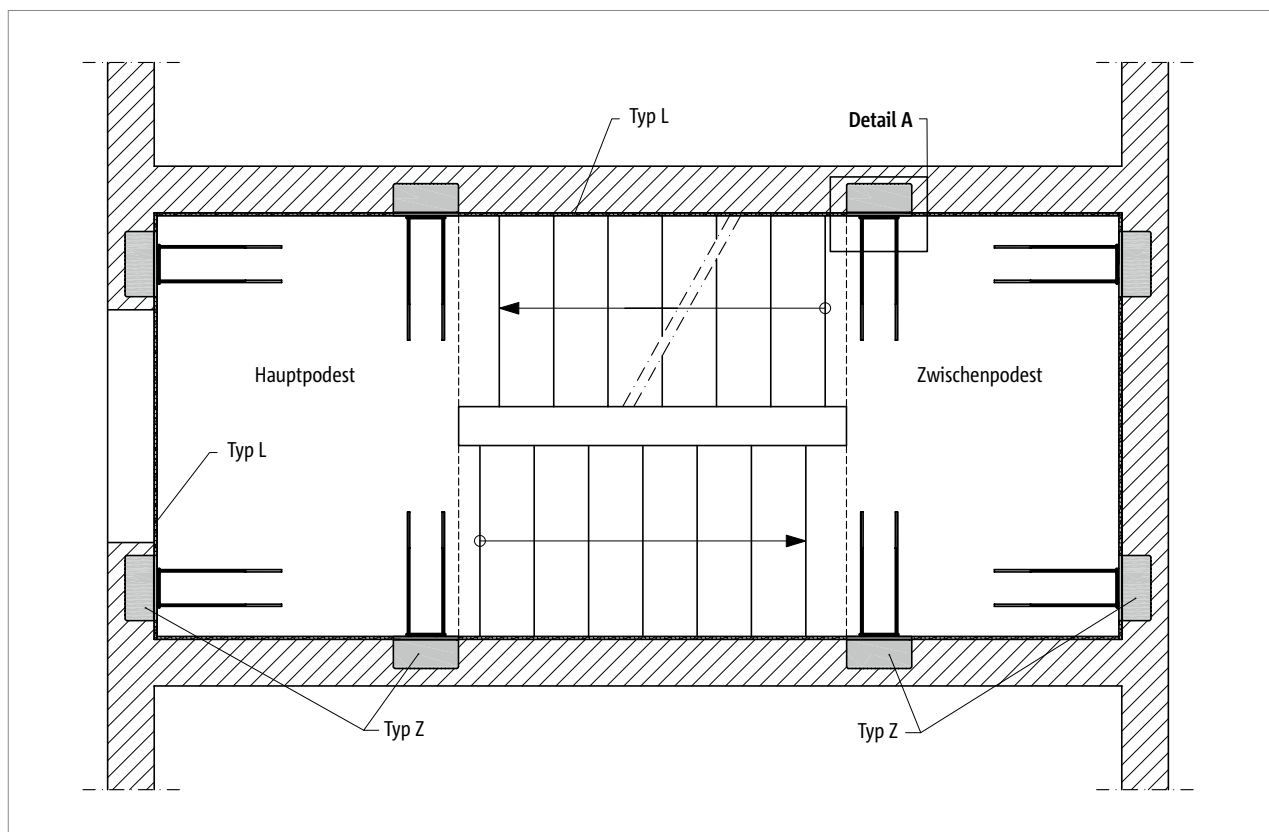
Schöck Tronsole® Typ Z: Alternative Elementanordnung im Grundriss
